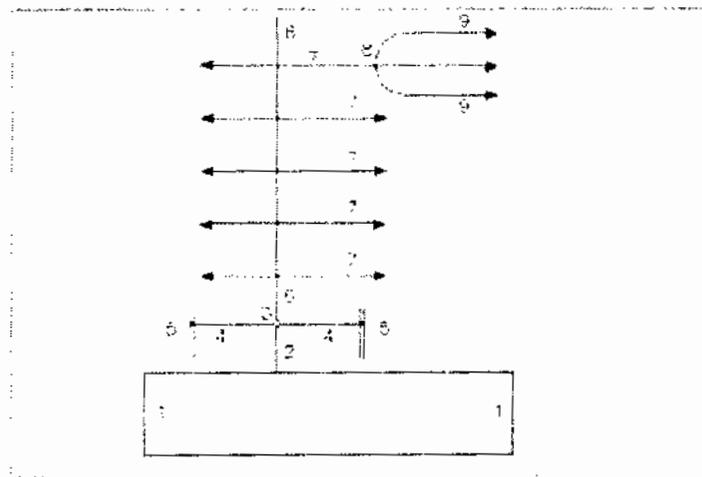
Installation de mise à la terre d'un bâtiment collectif
